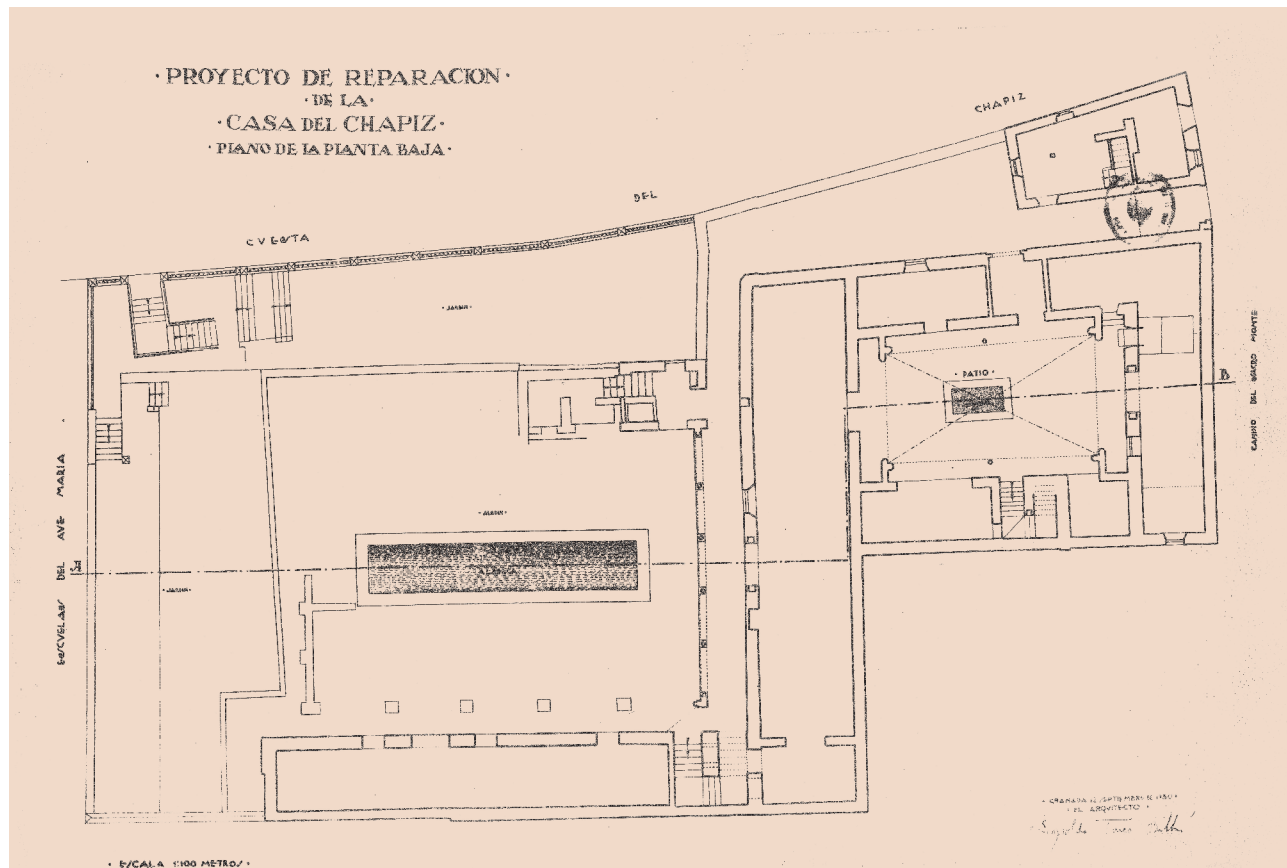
Proyecto de reparación de la Casa del Chapiz. Plano de la planta baja. LTB, 12 de septiembre de 1930. AGA, Educación y Ciencia, 13200-7.
